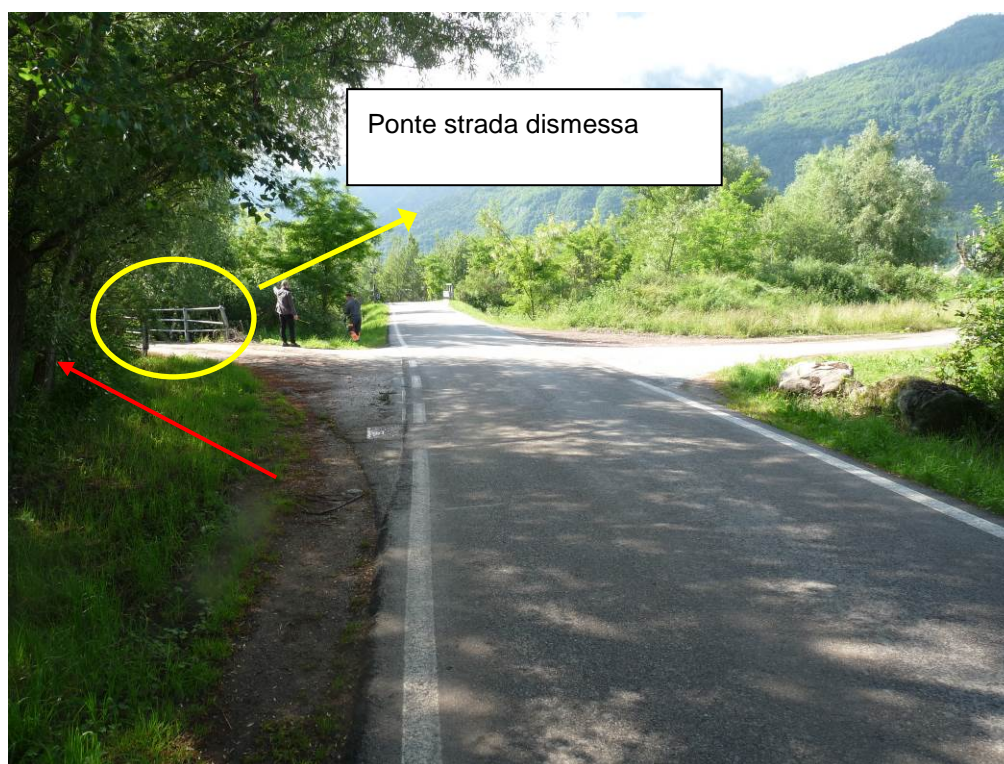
attraversamento roggia a fianco strada dismessa con passaggio sub alveo. Vista da nord
